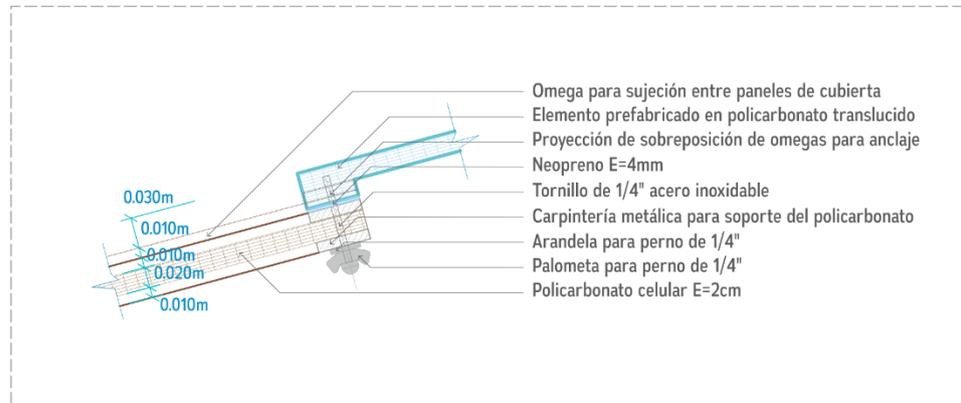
, Detalle de sujeción de elemento con paneles de cubierta, fuente: Autor.
